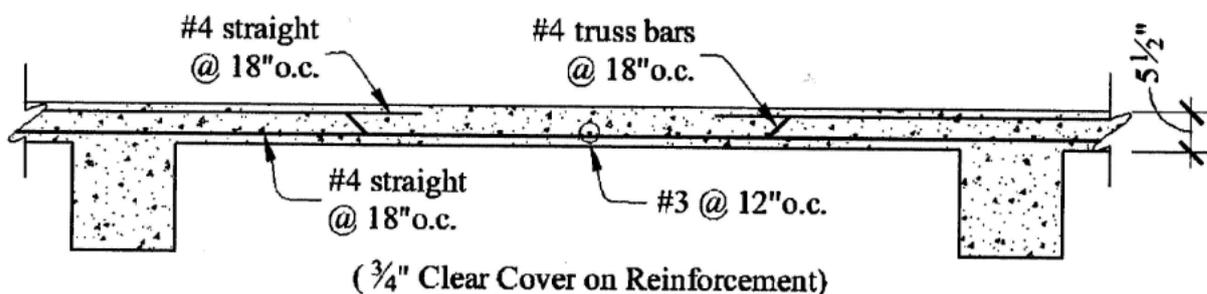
Конструкция плиты перекрытия здания Пентагона
